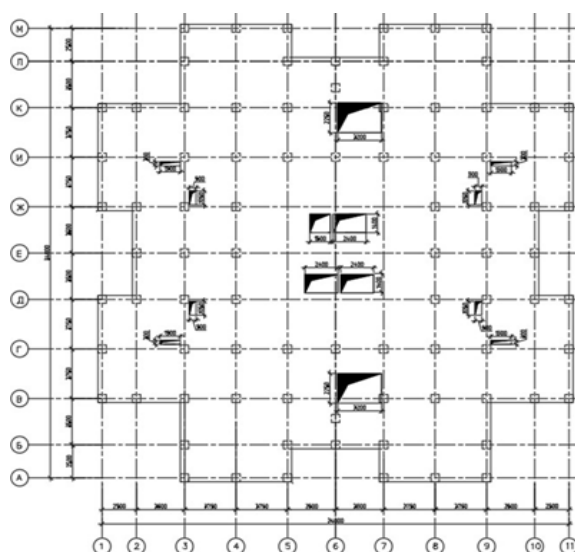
Монолітна безбалочна плита перекриття
